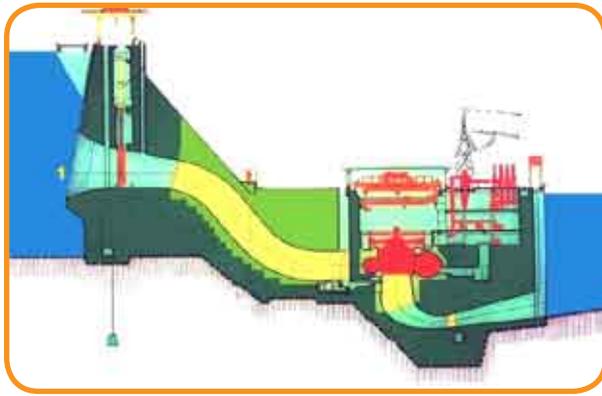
Seção transversal típica das estruturas de concreto da Tomada d'Água – Casa de Força, da 1ª Etapa.
